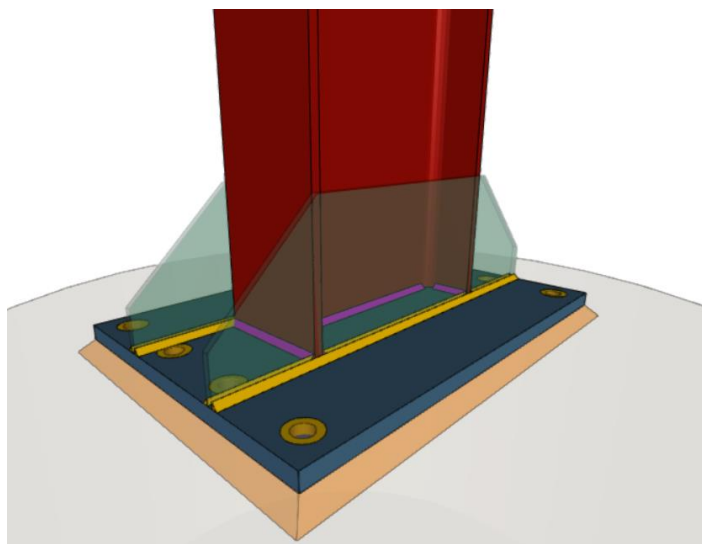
Imagen la unión del pilar con la placa base y de los rigidizadores
